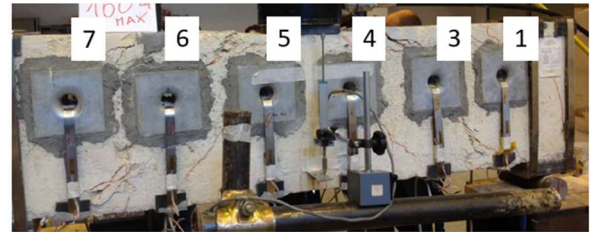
Fisuración diagonal en rotura y nomenclatura de las bandas. Viga TG-P-N-20P/A
